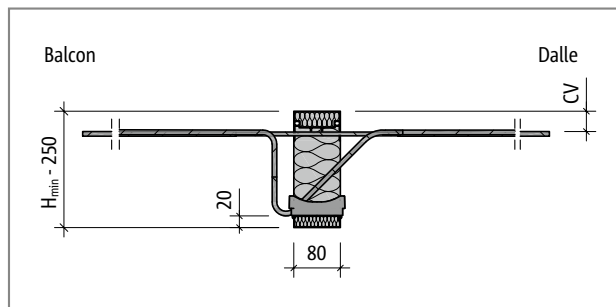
Schöck Isokorb® T Type K-T-M1, K-E-M2, K-T-M3 : Coupe du produit
